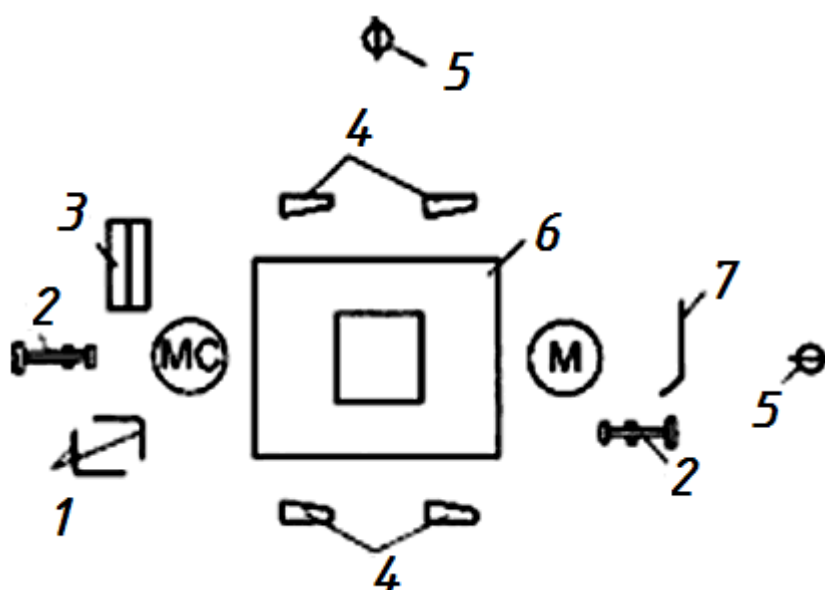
Схема организации рабочего места при монтаже колонн в стаканы фундаментов:
